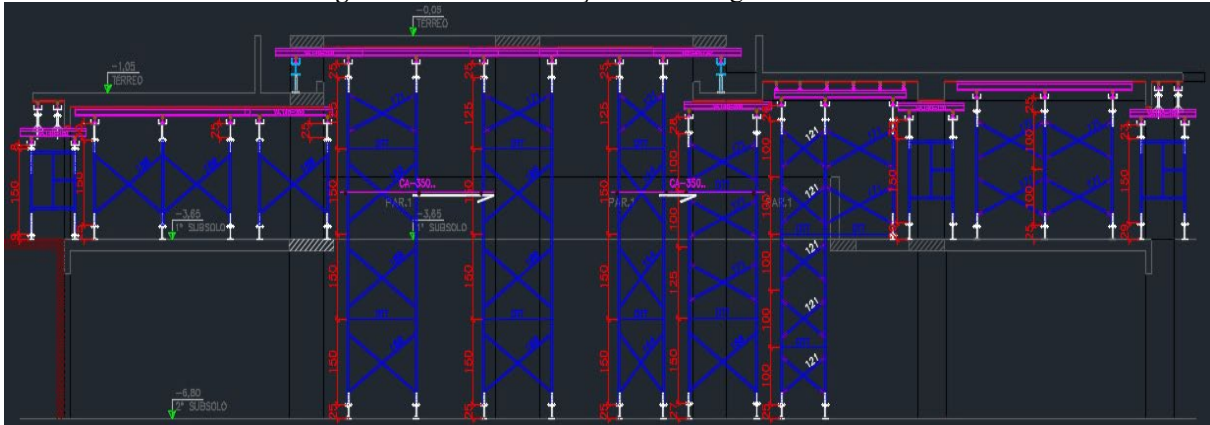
e 16, podemos identificar a planta de locação e corte de torres vigas de alumínio para o fundo de laje.
